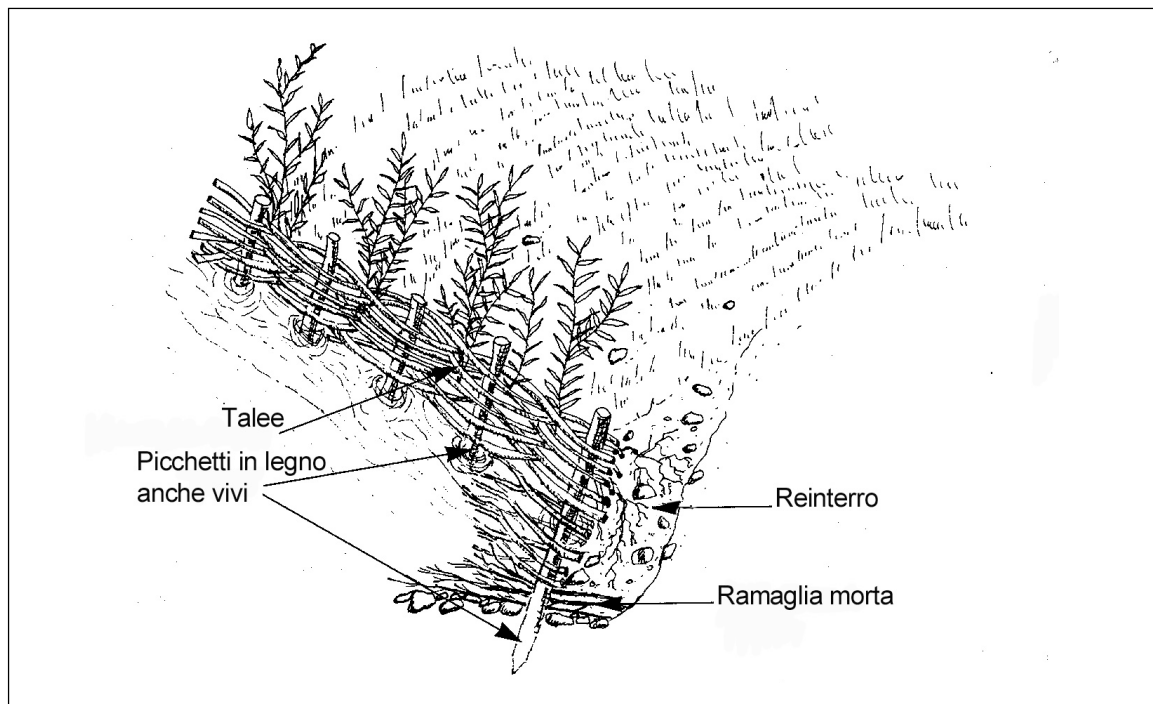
Viminata viva spondale: prospettiva*Modalità di esecuzione:
